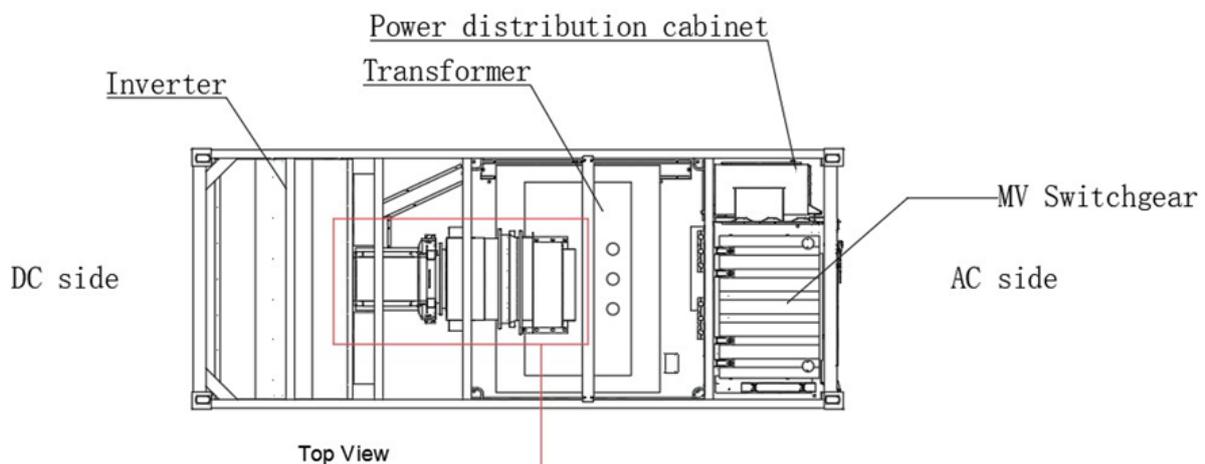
pianta Cabina di Trasformazione MT/BT
